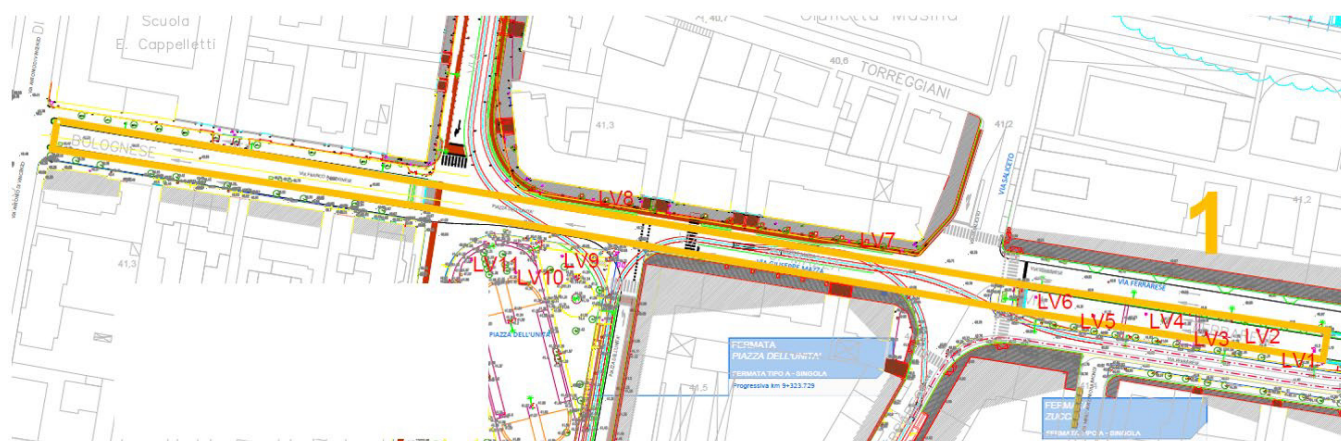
dettaglio del posizionamento dei carotaggi LV1 – LV11 sulla planimetria di progetto
